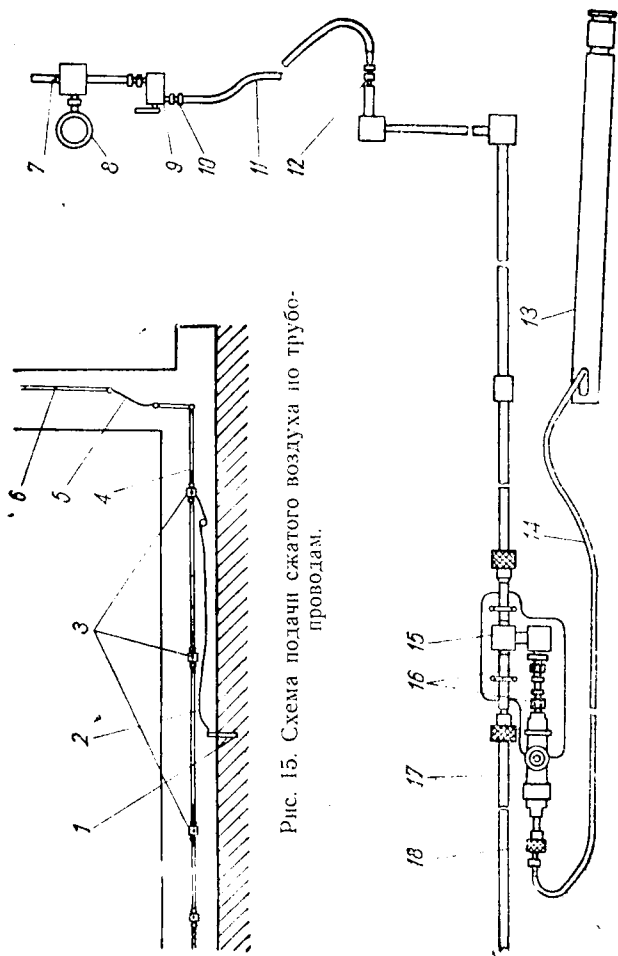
Схема подачи сжатого воздуха по трубопроводам.
